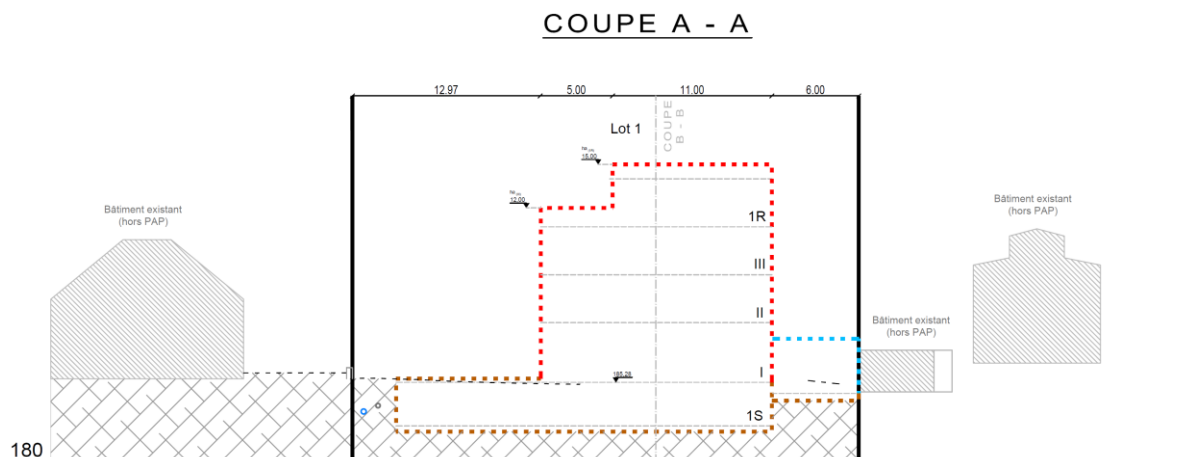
Coupe A-A du PAP. (Source : BEST)
